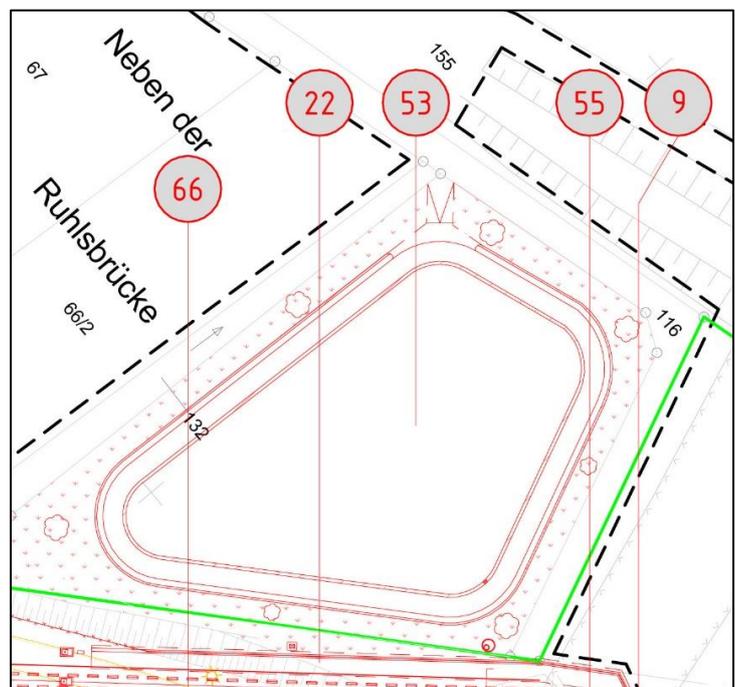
Ausschnitt aus dem Lageplan P03-2 mit Darstellung der Versickerungsanlage im Landschaftsschutzgebiet mit der Bauwerksnummer 53, außerhalb der bisherigen Bahnflächen (grüne Linie).
